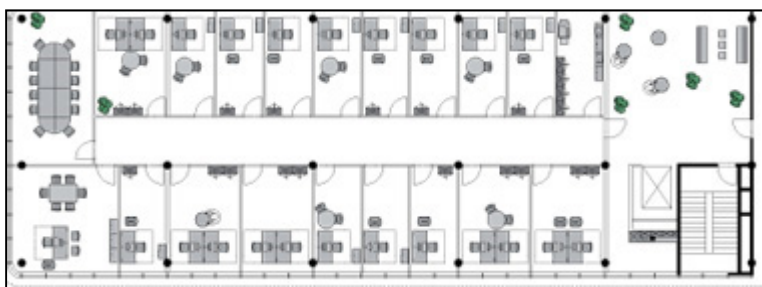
Beispiel für den Grundriss eines Zellenbüros
